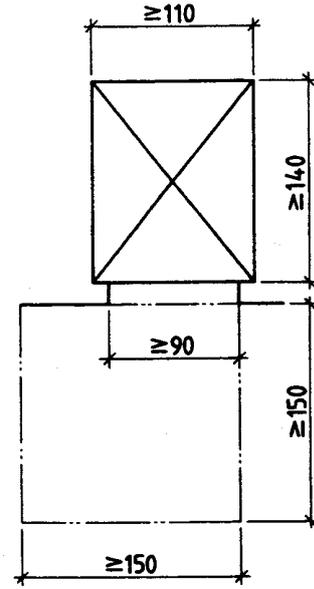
Lichte Maße des Aufzugsfahrkorbs und Bewegungsfläche vor den Fahrschachttüren
